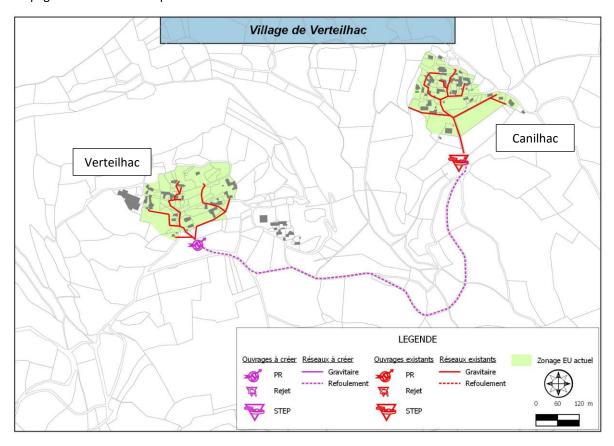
Raccordement du village de Verteilhac à la station d'épuration de Canilhac
